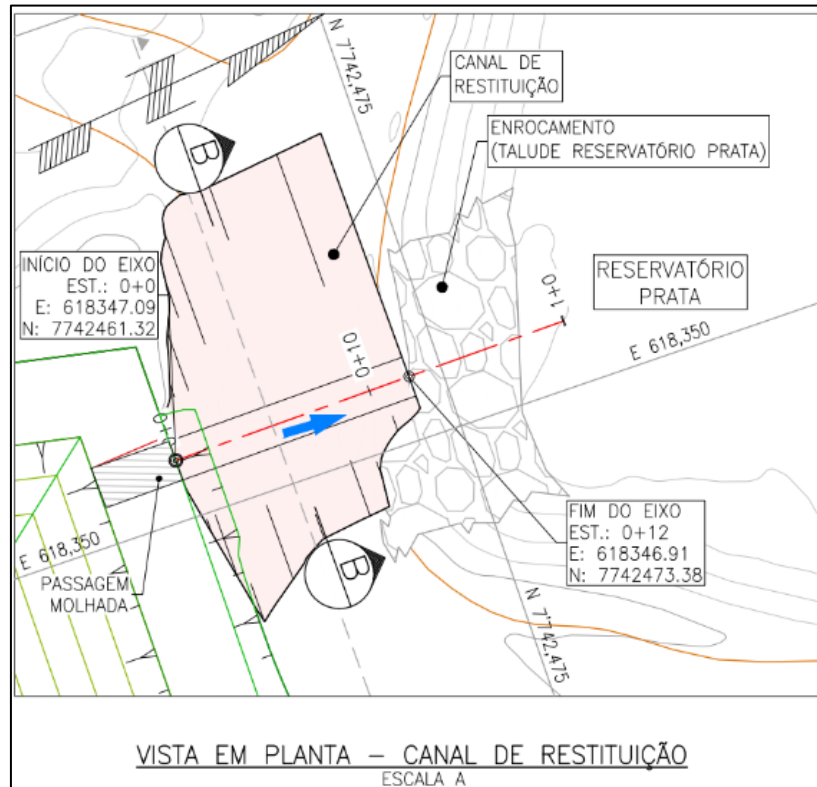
Vista em planta do canal de restituição. Fonte: 1850HH-X-39804.
